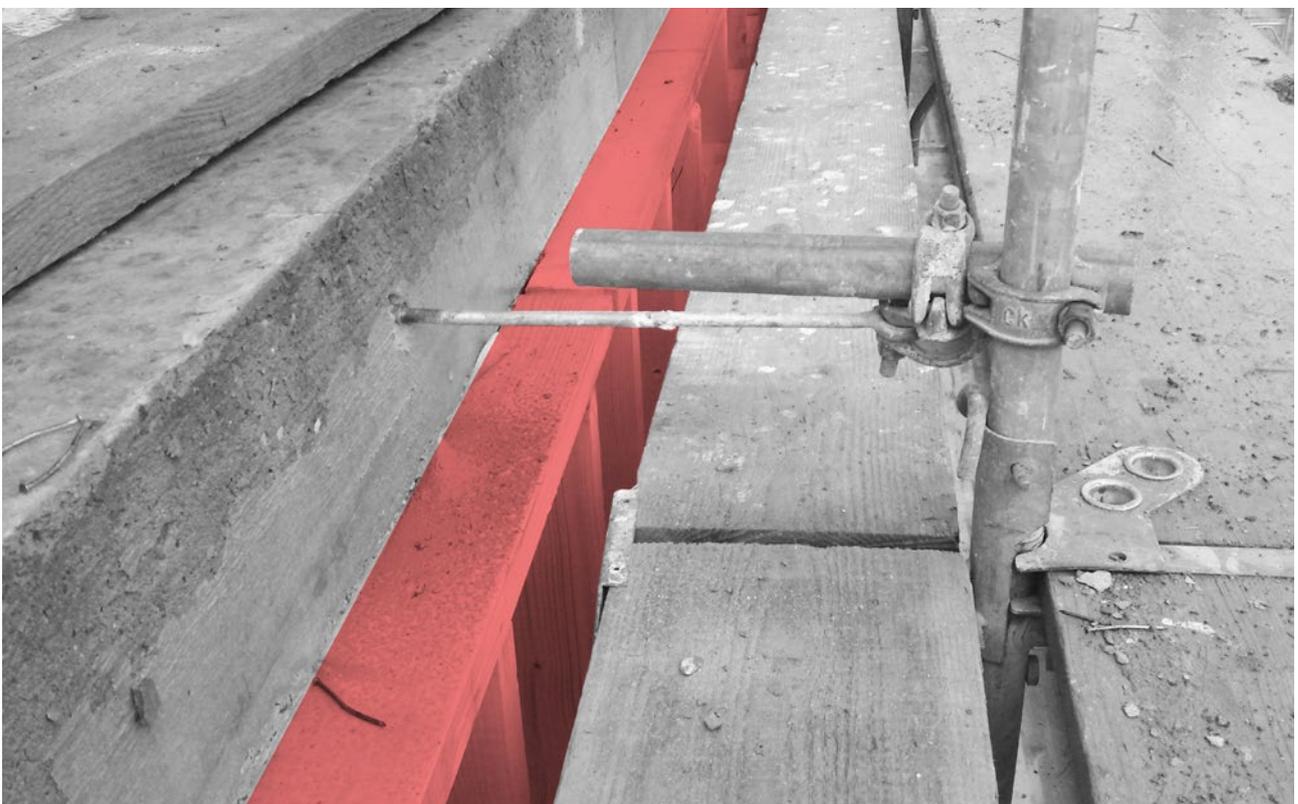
Baustellenfoto Anschluss der Holzfassaden an die Stirn der Betondecke
